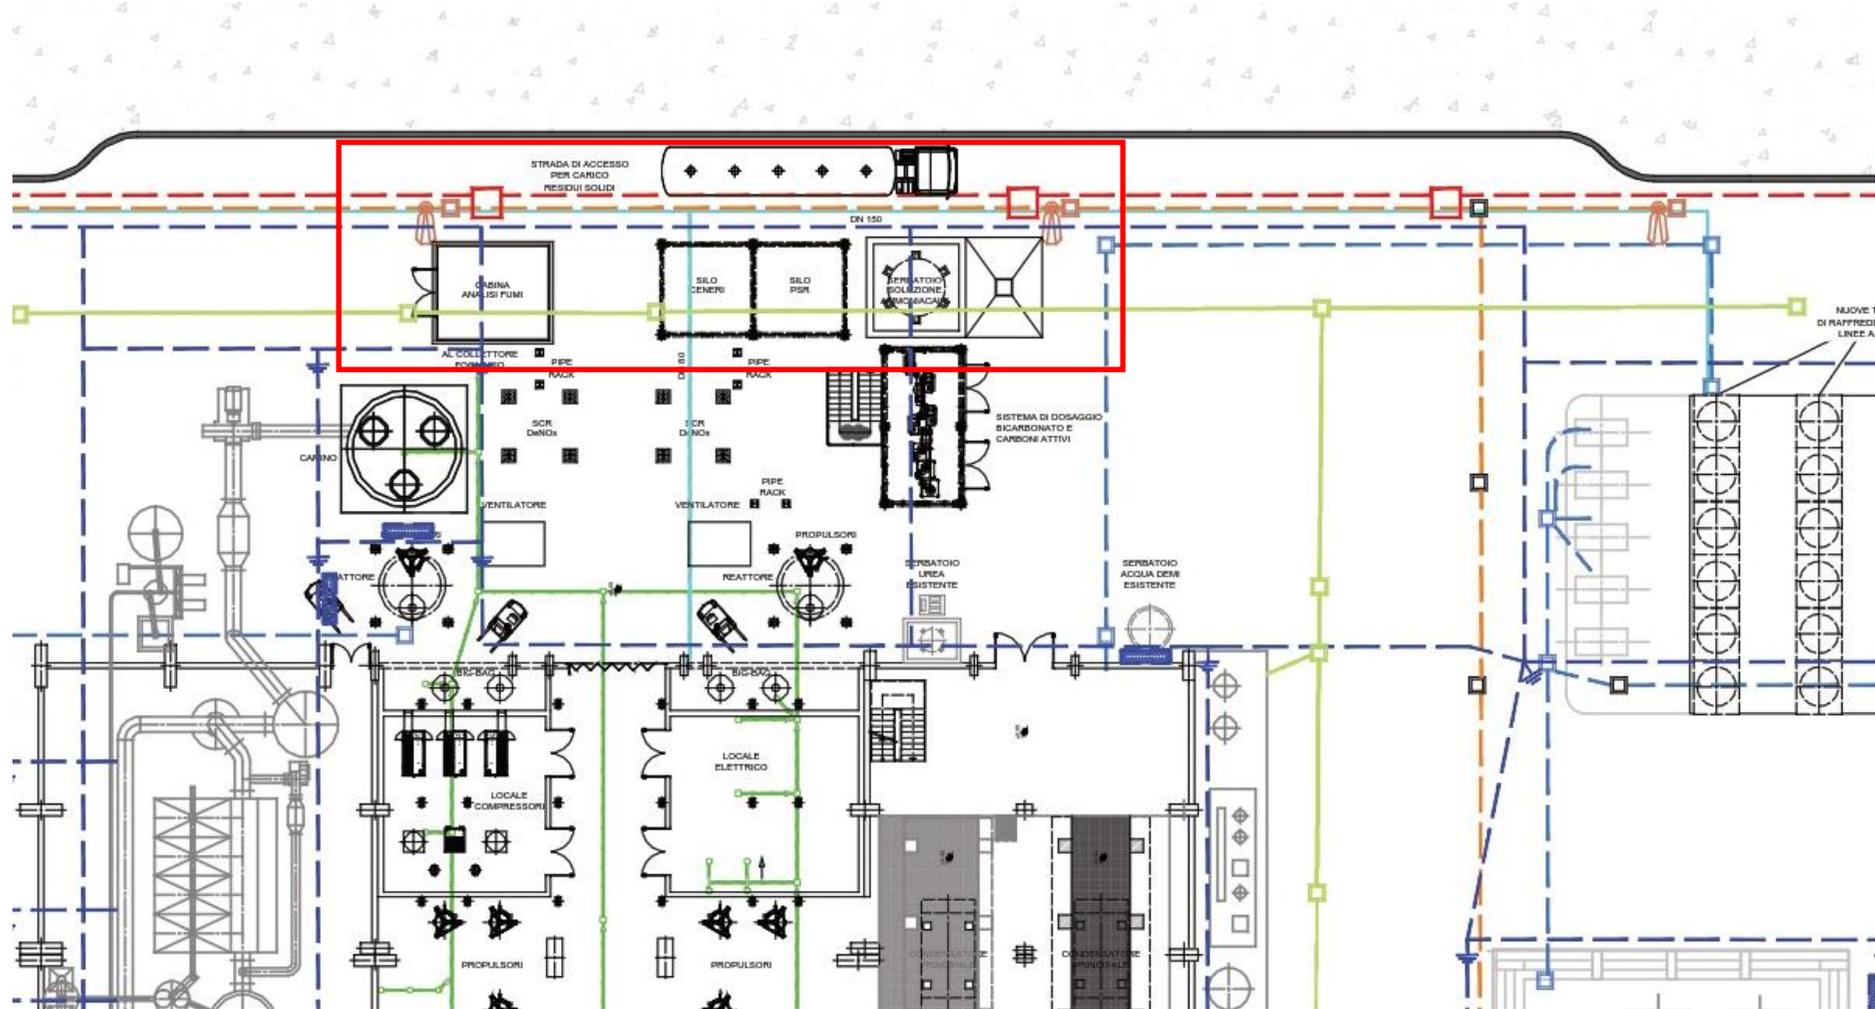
Stralcio di planimetria con reti interrate nella zona oggetto di intervento
